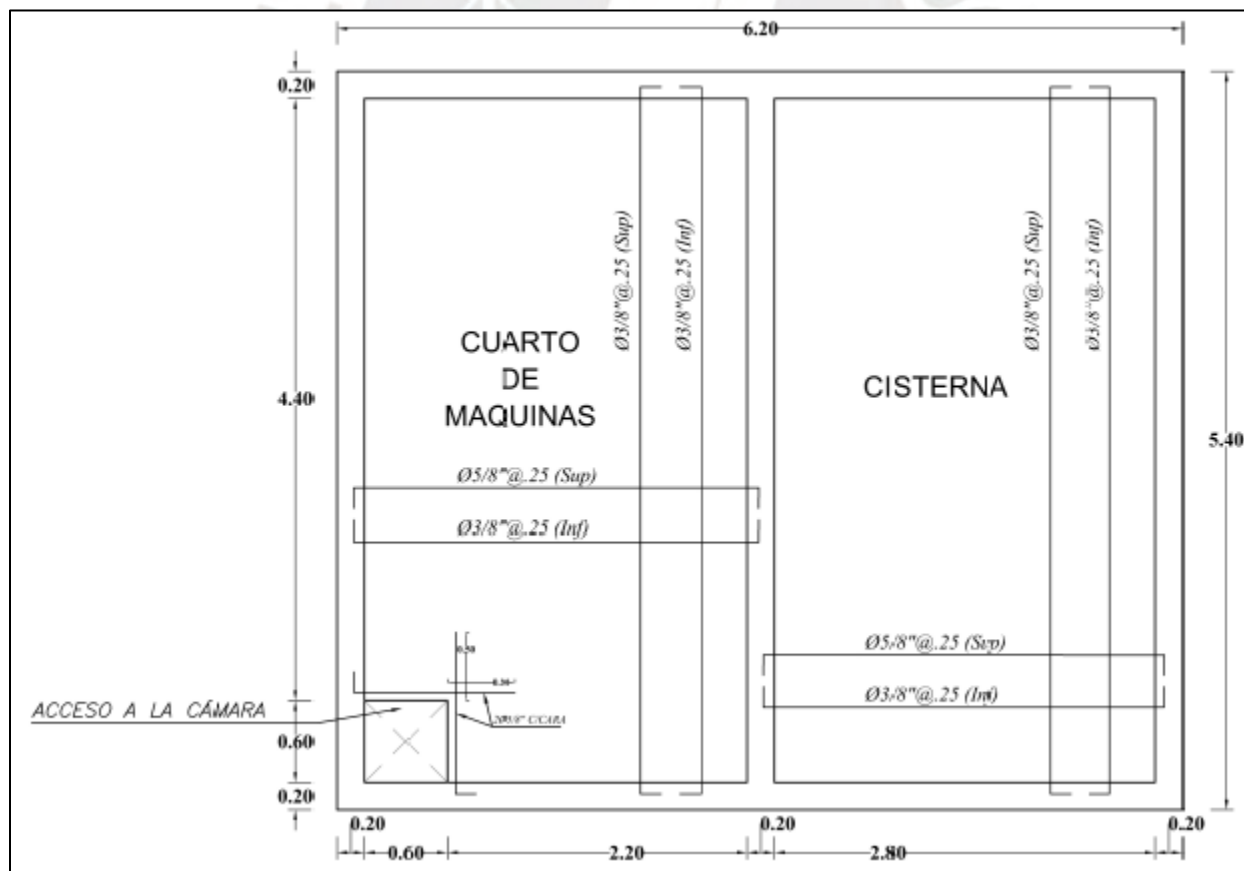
Armado en planta de la cisterna y cuarto de máquinas.
